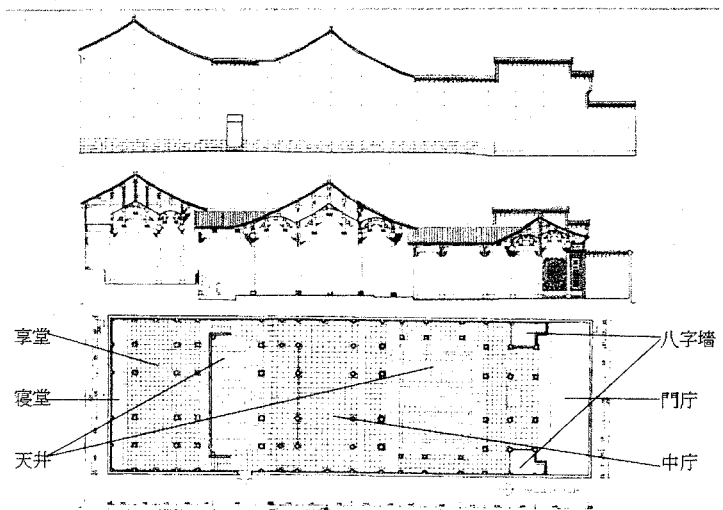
清懿堂の側面図、断面図と平面図（『徽州古建築叢書——棠樾』より）
